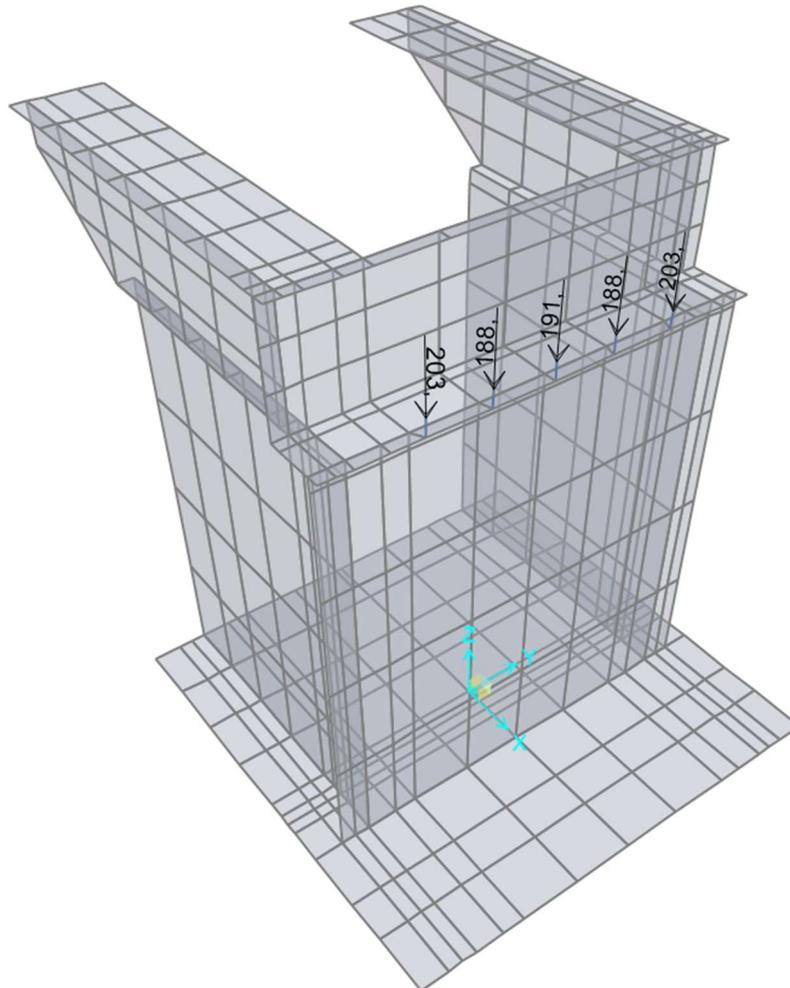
Modello FEM – Vista assonometrica carichi permanenti strutturali impalcato dall'impalcato in kN (imp_perm)
